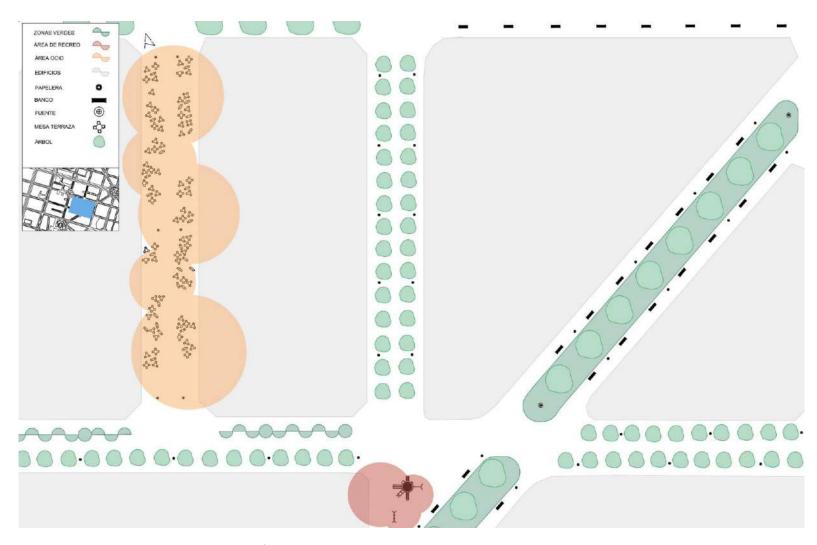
Plano de detalle 4. Escala 1:500 (A3).
